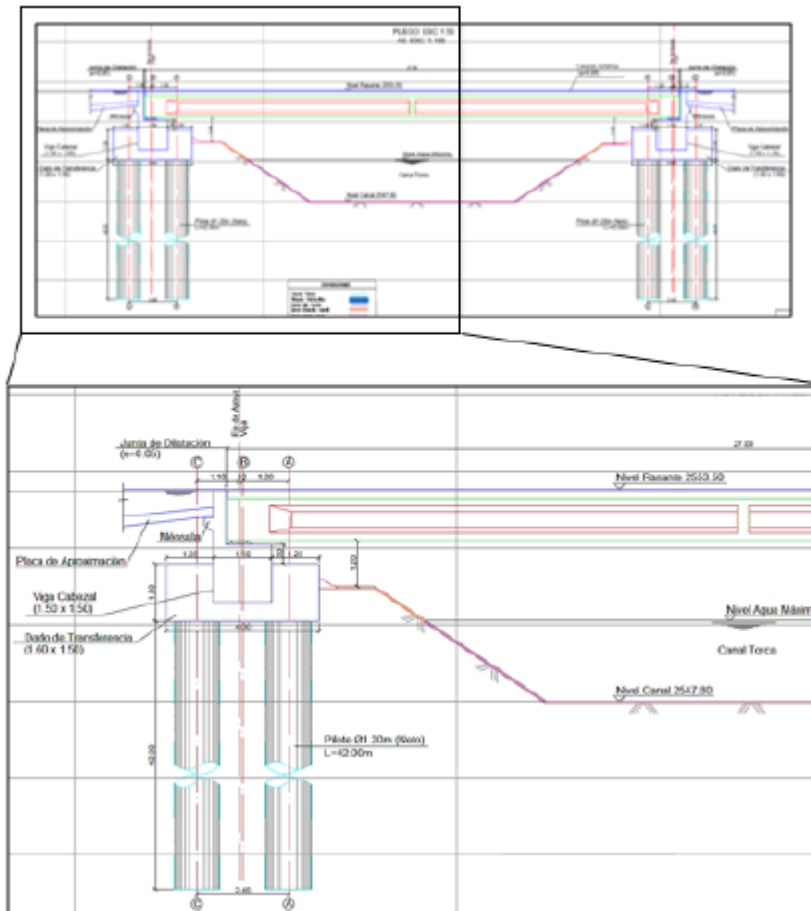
Plano perfil longitudinal del puente vehicular sobre el canal Torca, a la Altura de la Avenida Calle 183.
